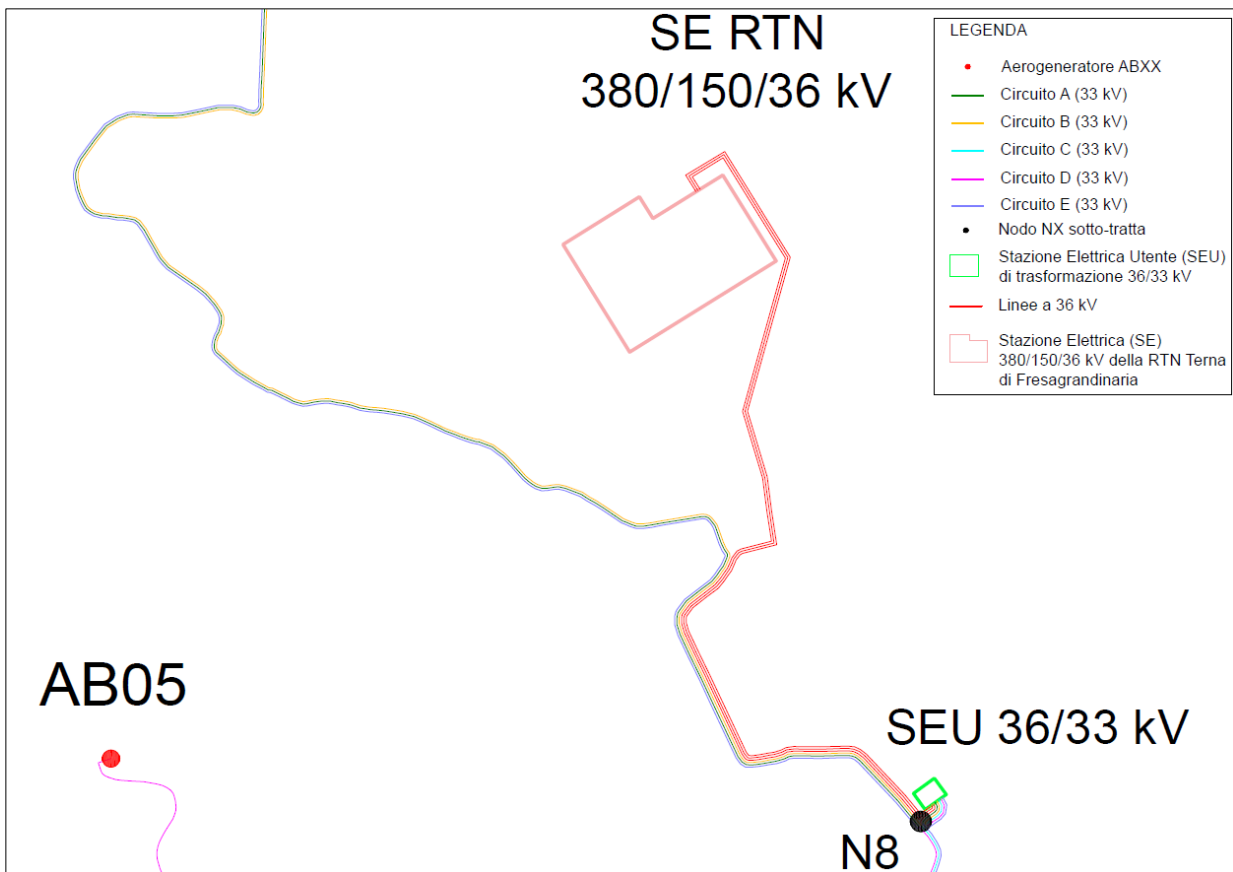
Dettaglio 3 di 4 della planimetria generale di distribuzione linee elettriche
